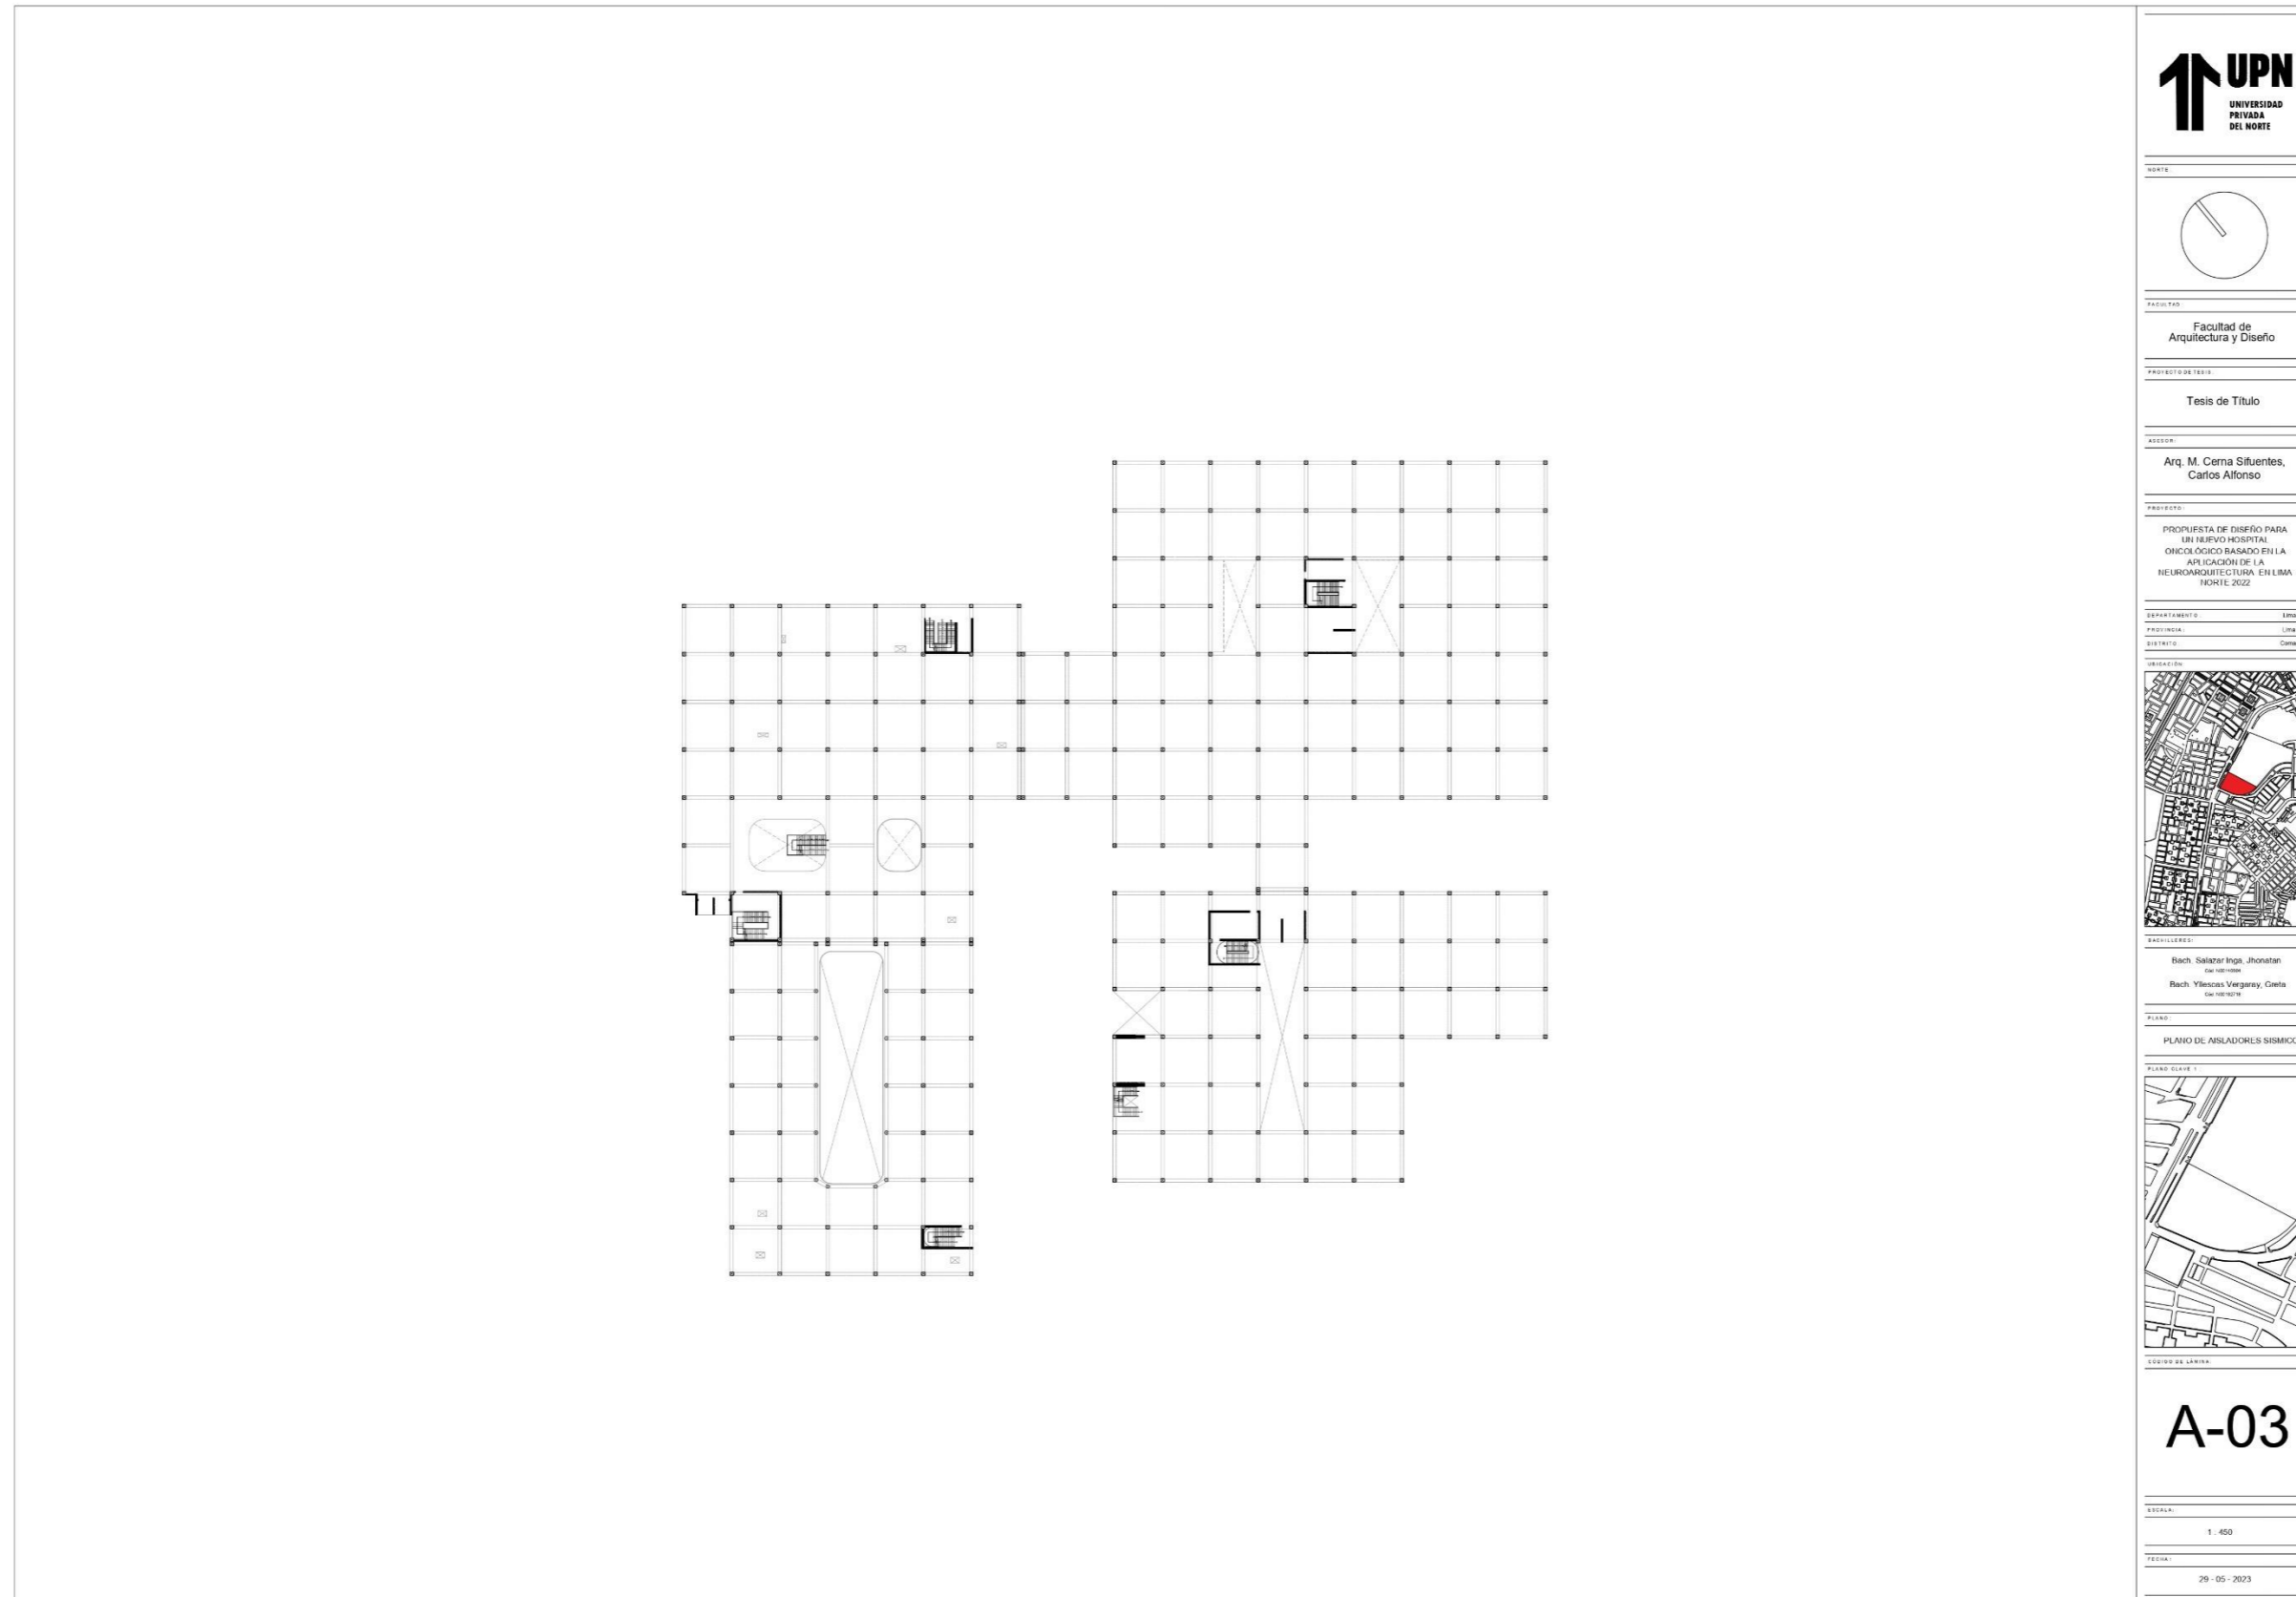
Arquitectura – Plano de Aisladores sísmicos Esc: 1/450 (Fuente: Elaboración propia de los coautores)
